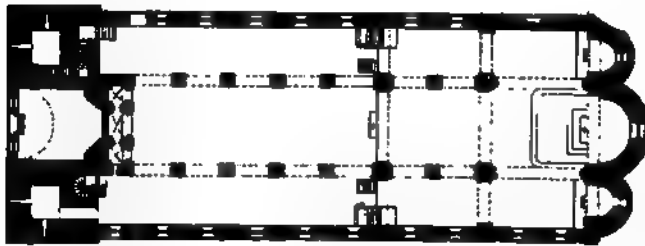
Grundriss einer romanischen Basilika (Dom zu Gurk)
